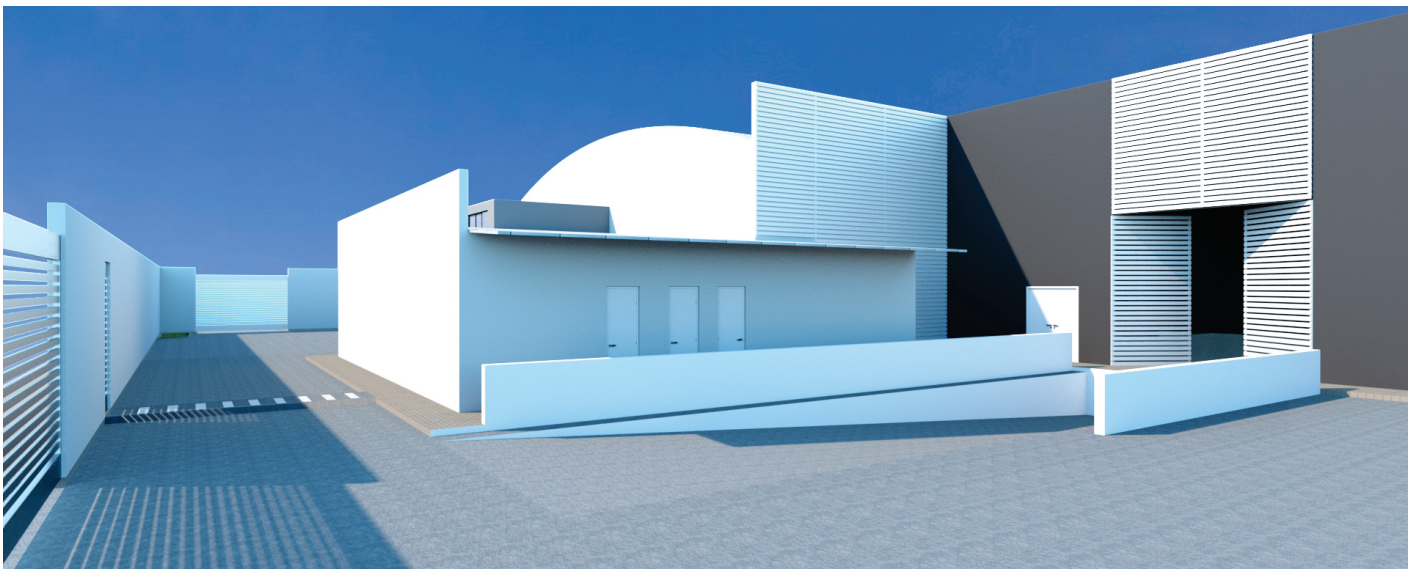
IMAGEM: PROPOSTA DE PROJETO PARA BARRACÃO - ÁREA DE SERVIÇO E DOCA
